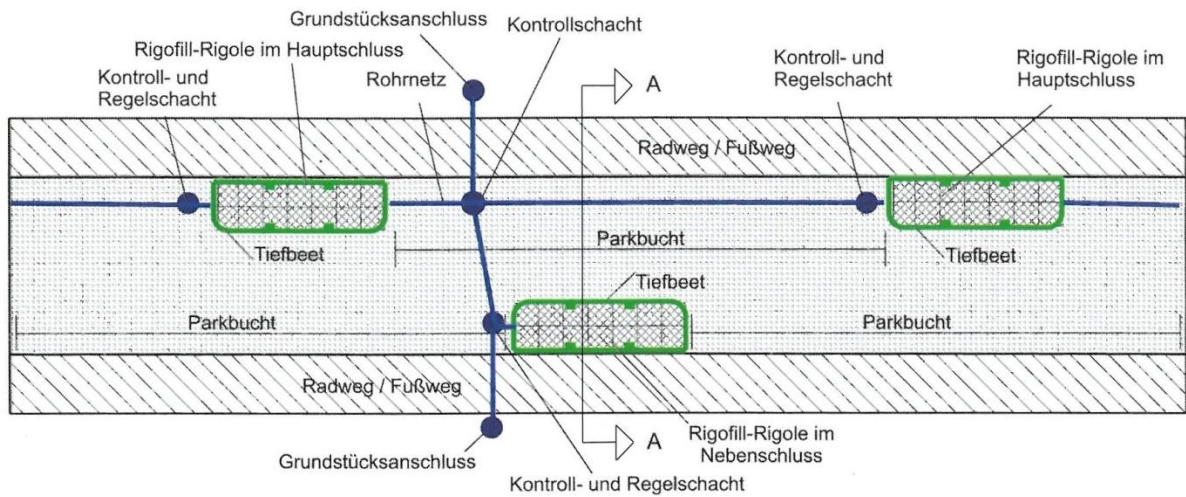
Tiefbeet-System im Lageplan mit Vernetzungselementen
